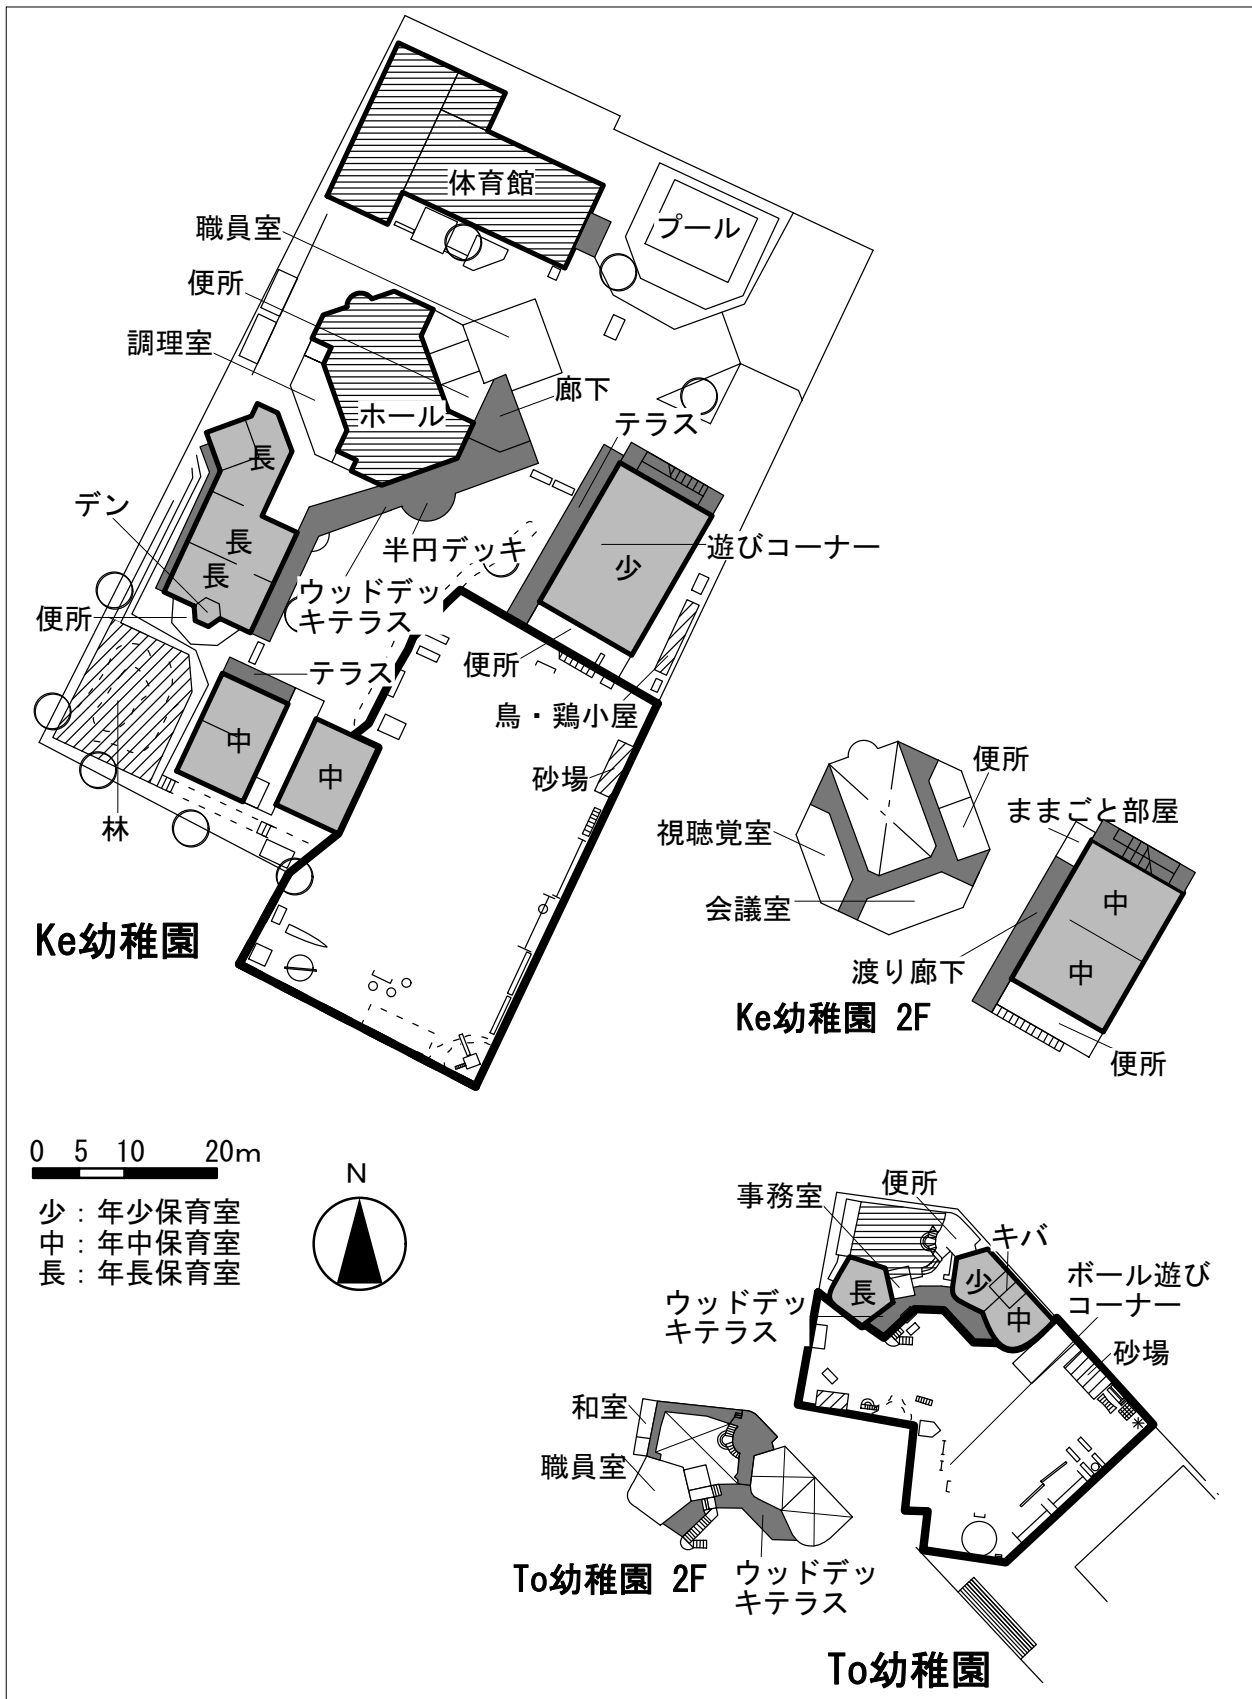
調査対象幼稚園の配置図・平面図 (拡大) Ke 幼稚園・To 幼稚園
